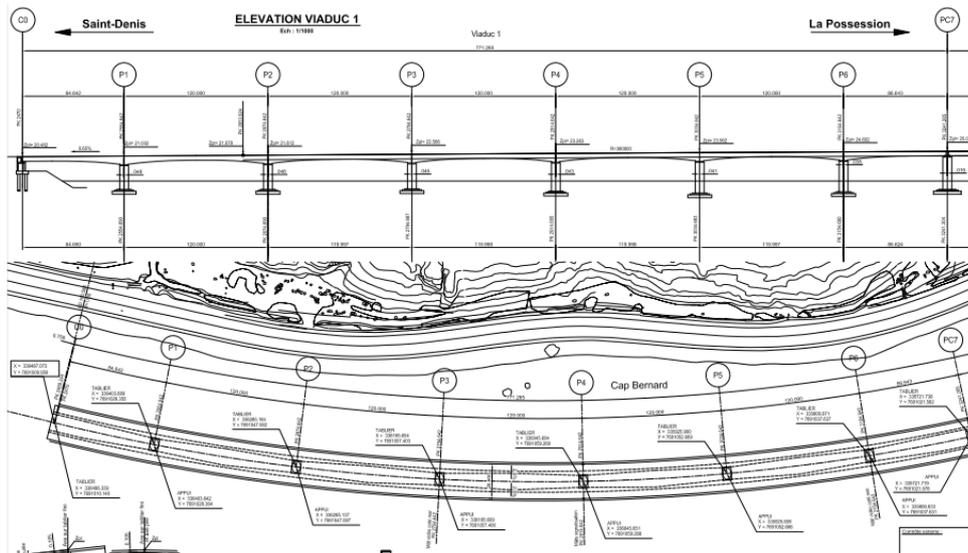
élévation et vue en plan du viaduc 1 – Est-
